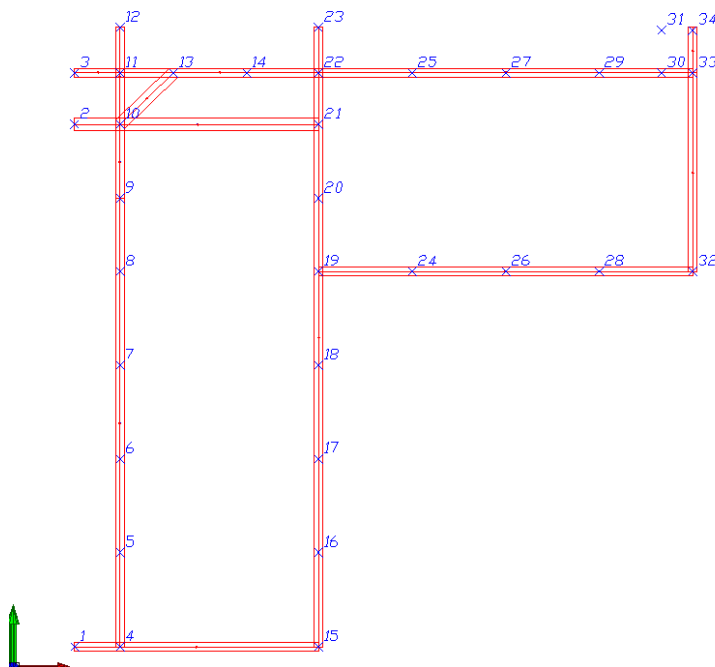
1 – Pianta chiave numerazione travi e pilastri.
